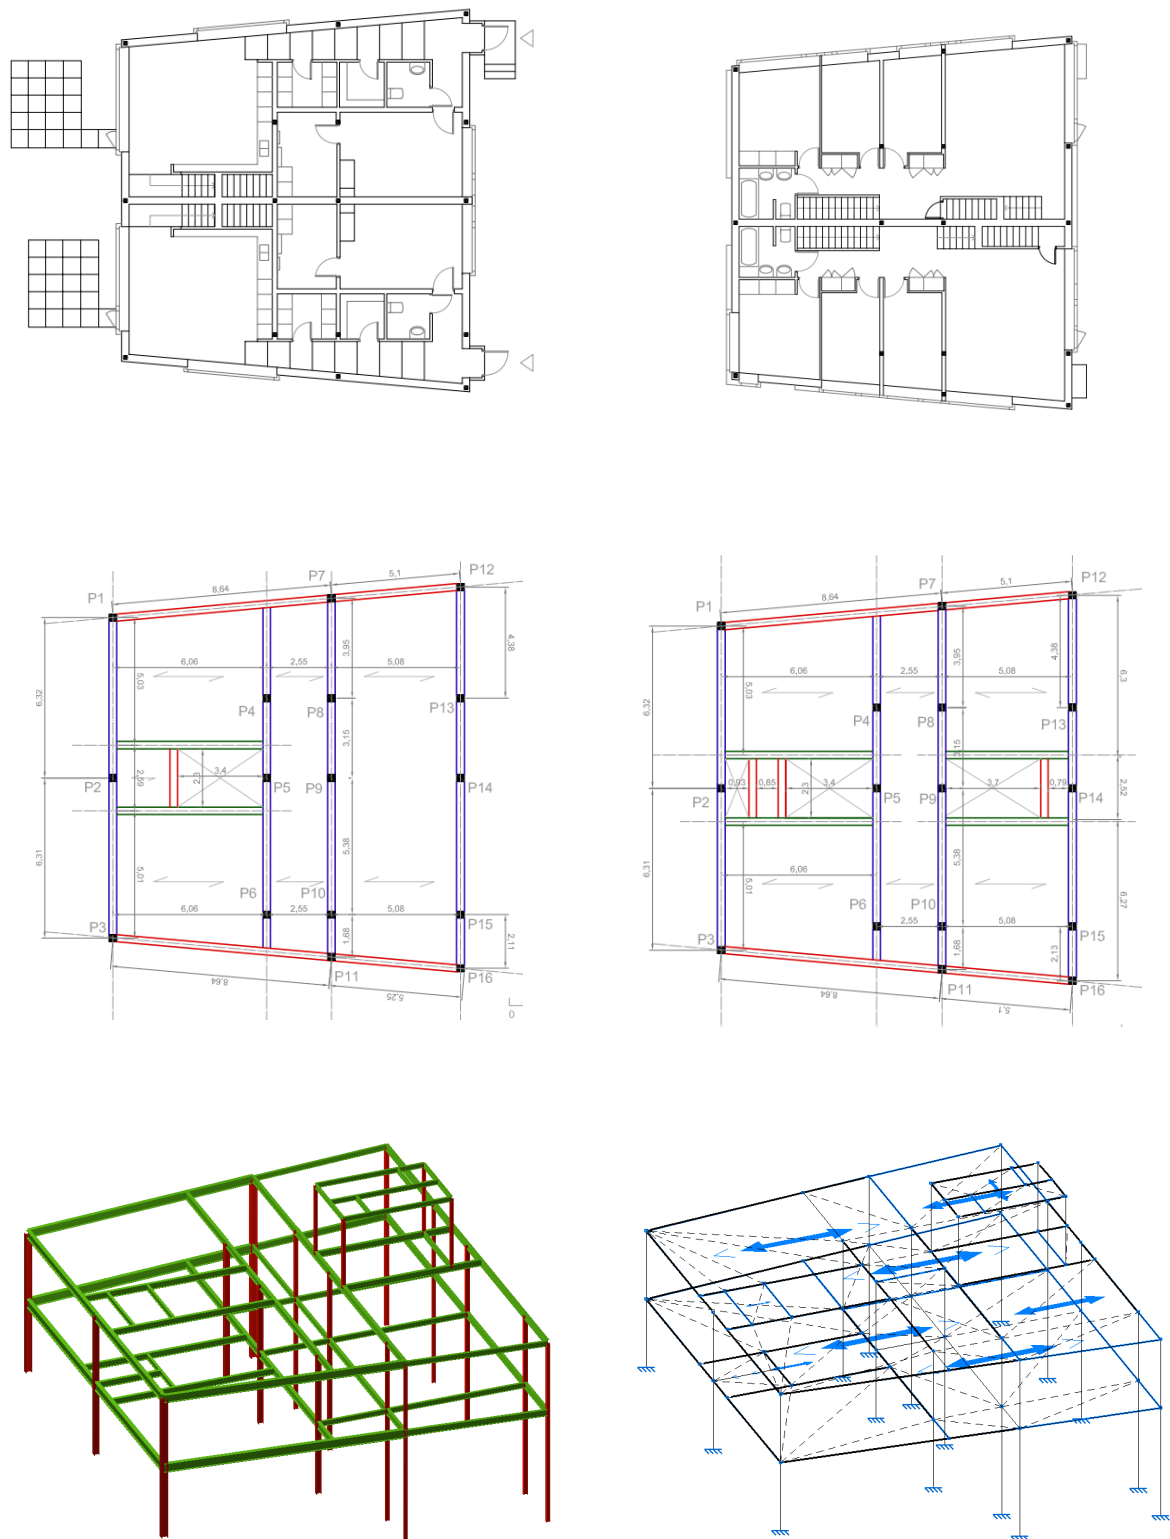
Proyecto realizado por uno de los equipos de estudiantes en el curso 2012/13 para la Nora house, Danderyd, Suecia, 2005 (arquitectos: Tham y Videgård Hansson). Plantas arquitectónicas, plantas de la estructura diseñada, vista extruida y vista de alambre en la aplicación NM3D de CYPE, utilizada para el análisis estructural
